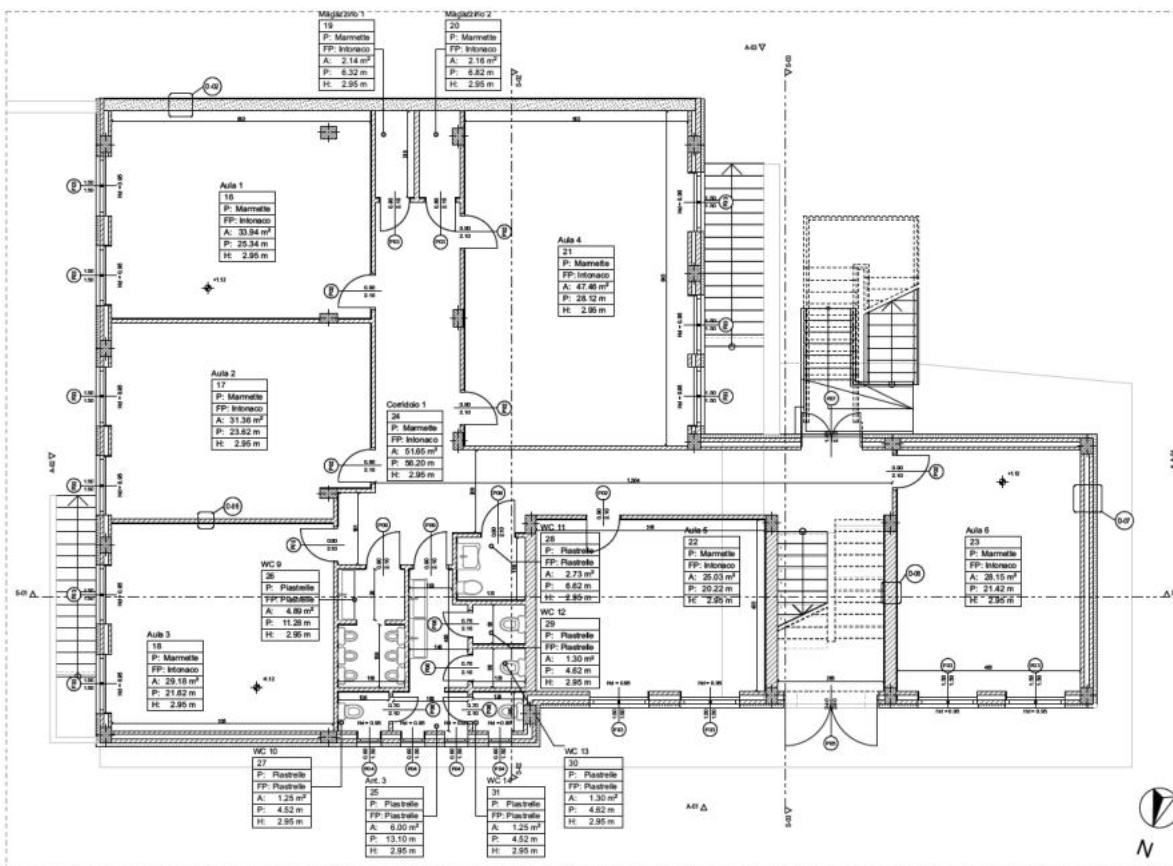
Stato dei luoghi. Pianta Piano Rialzato
